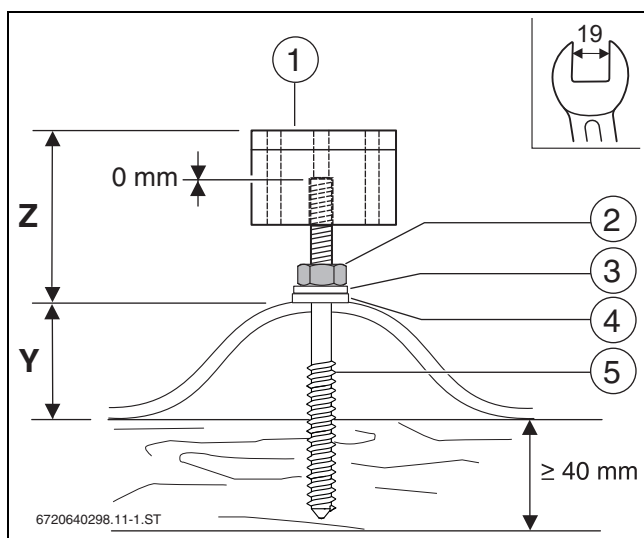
Tornillo de doble rosca montado con caballete de soporte
